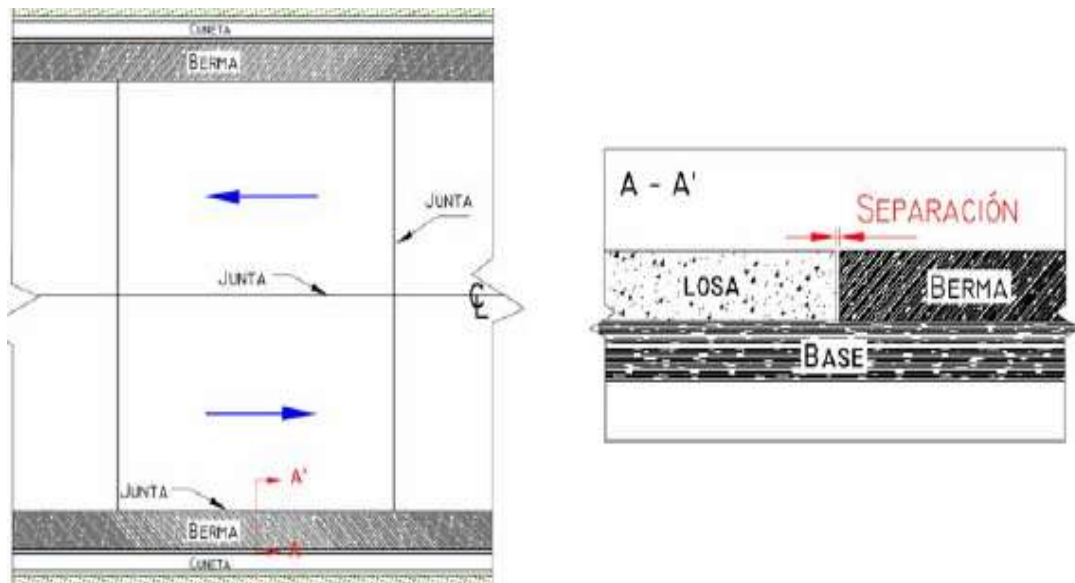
Separación entre la berma y el pavimento (SB) (INVIAS, 2006).
